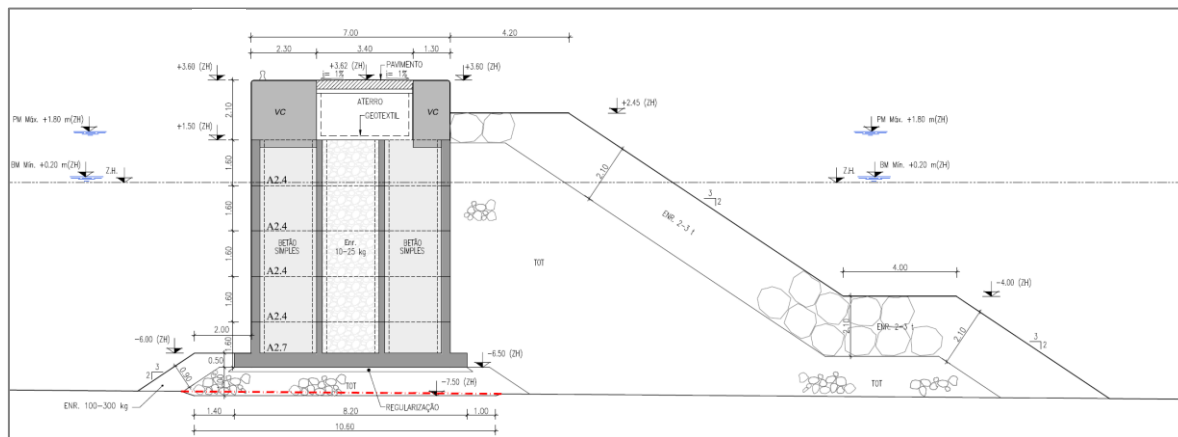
Obra de Abrigo Poente - Perfil tipo da Estrutura
